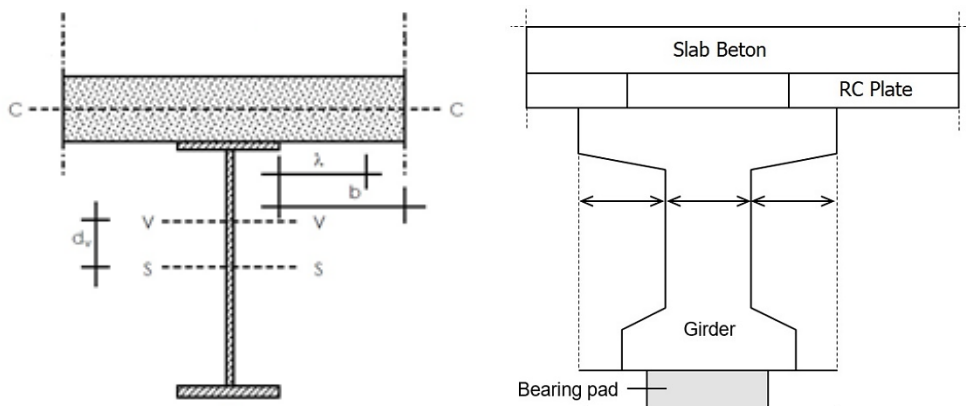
Permodelan Konstruksi Girder *Precast* Beton
